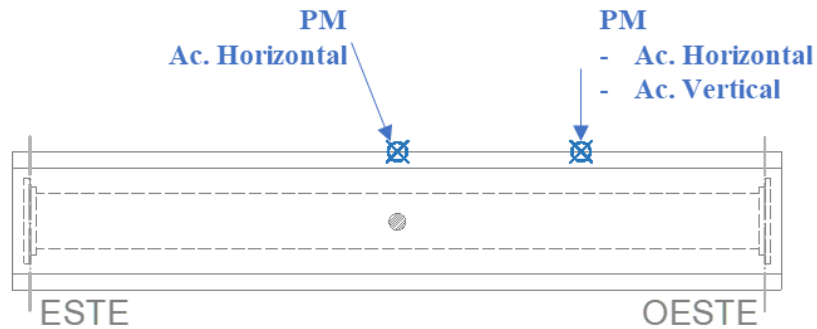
Posición de los acelerómetros en la planta del puente calle Boedo.
